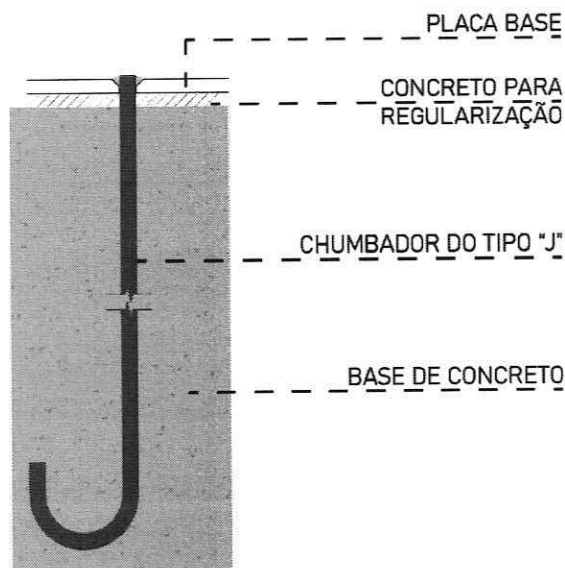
Detalhe da fixação da estrutura metálica na base de concreto armado
